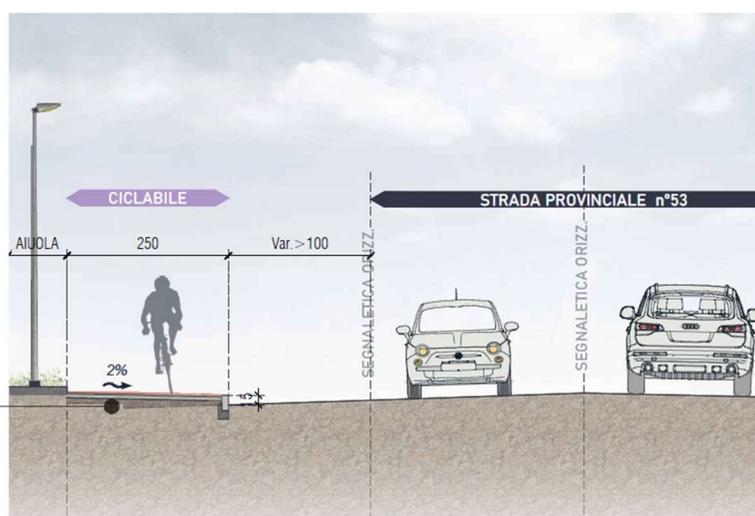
Sezione tipo su banchina stradale con pavimentazione in conglomerato bituminoso drenante semiaperto
